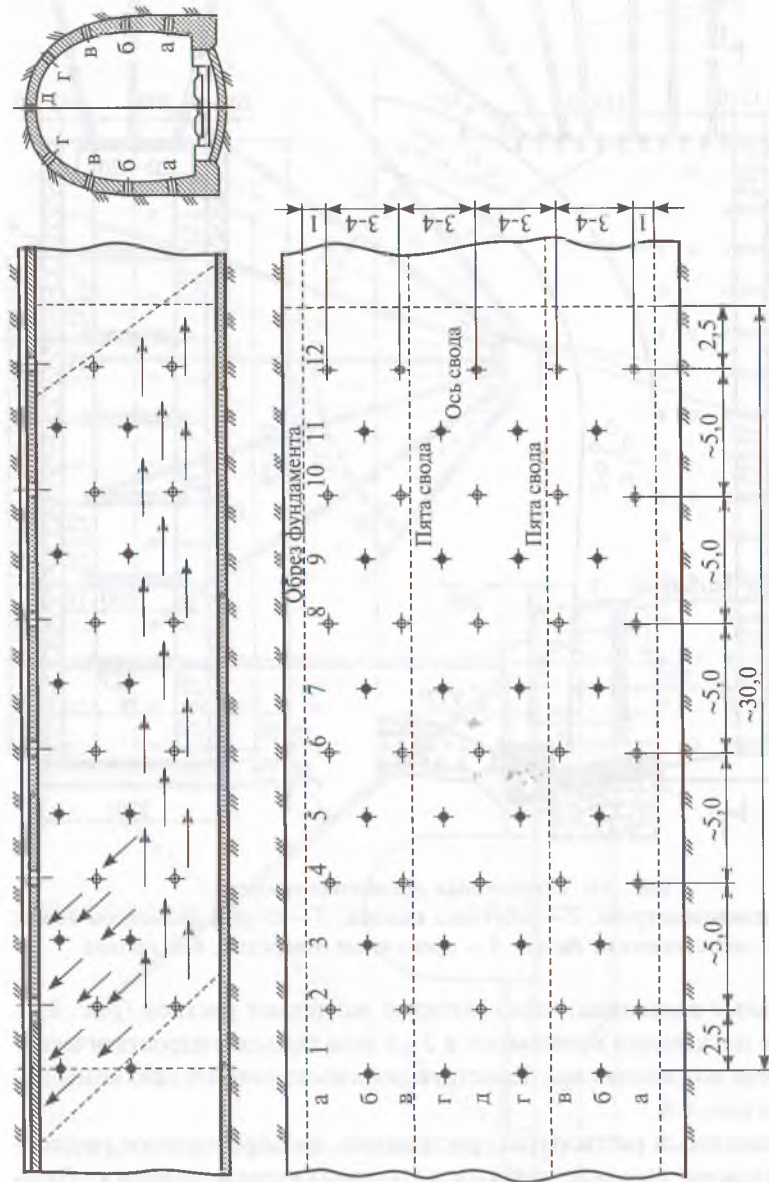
Схема нагнетания раствора за монолитную бетонную обделку
